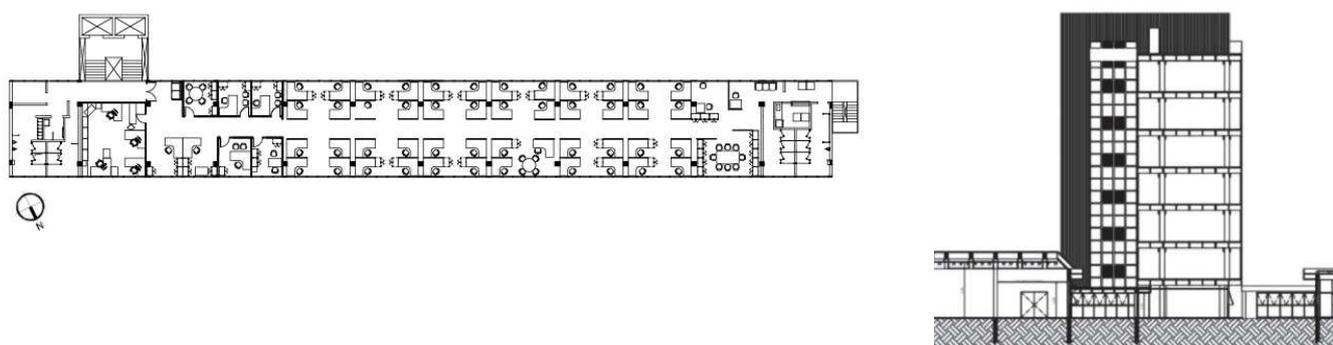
Planta e corte transversal da torre K do Edifício da Administração Central da USP.
